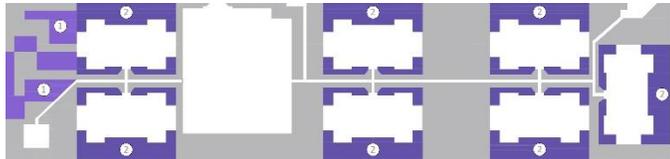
Equipamiento Don Eduardo. Fuente: Elaboración propia.
